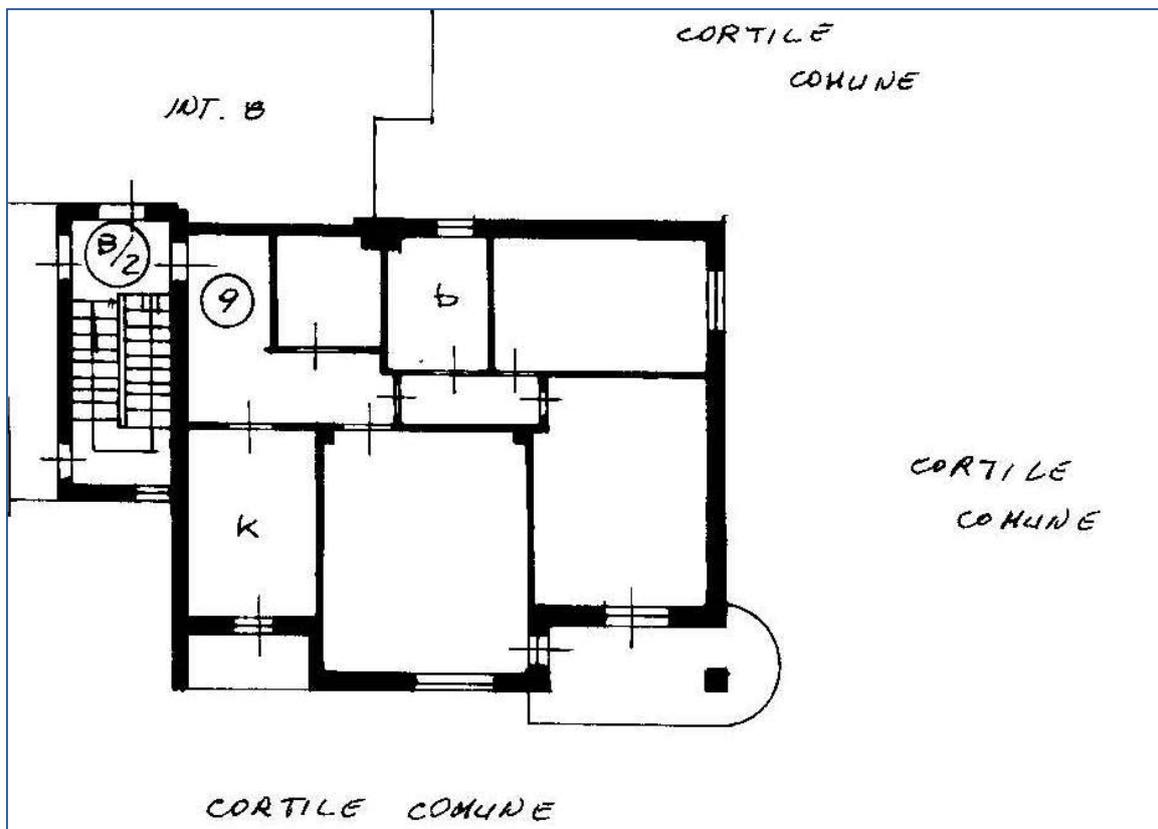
Estratto della planimetria catastale - schema planimetrico rilevato
